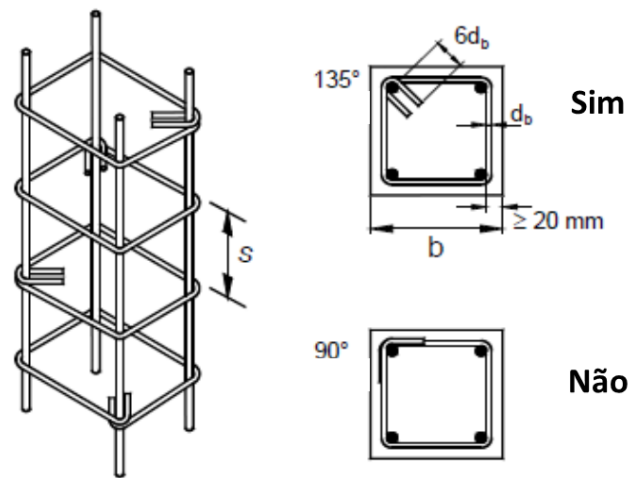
Reforço transversal em pilares (Meli e Brzev (2011)).
